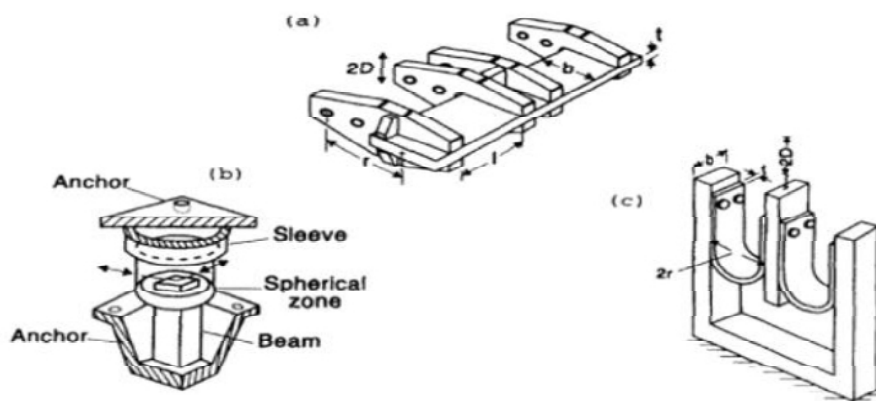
Dispositifs amortisseurs métalliques a) poutre de torsion ,b) poutre de flexion , c) la bande-u) [3]
